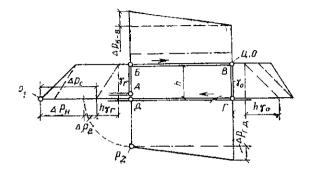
Эпюра гидравлического давления в местной системе отопления, непосредственно соединенной с наружными теплопроводами
